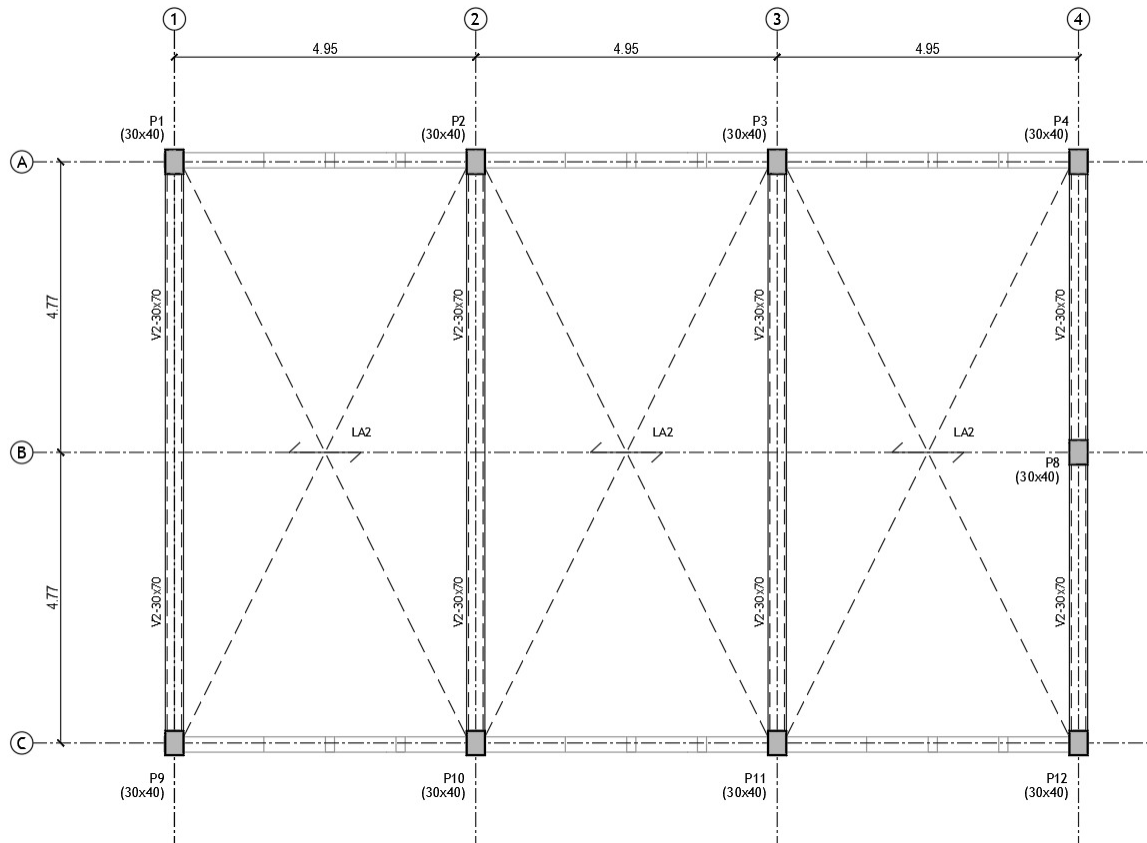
Identificação dos pilares e vigas e da orientação das lajes no piso 2
